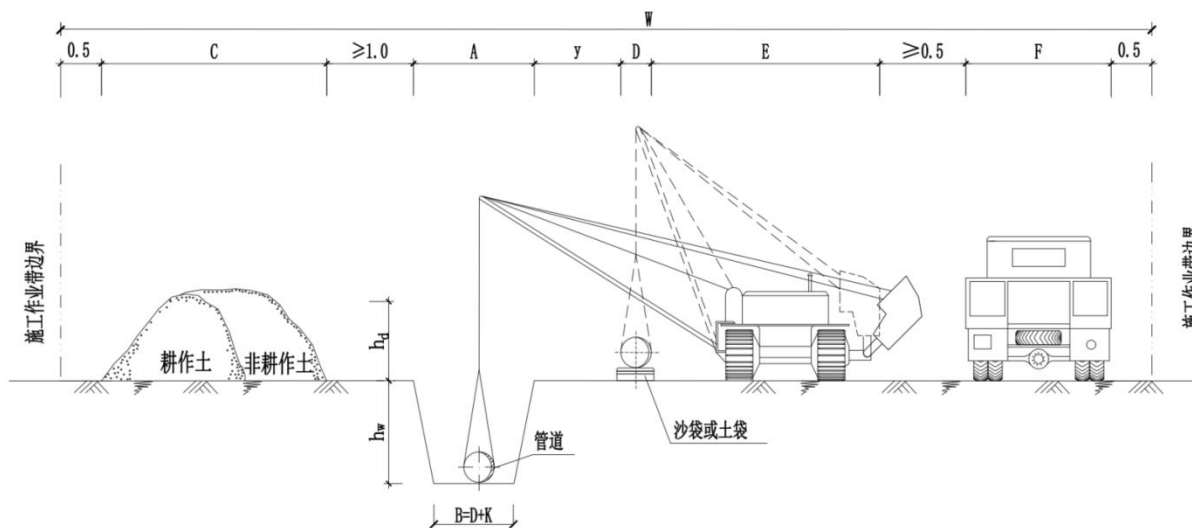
沟上焊施工作业带布置典型图
